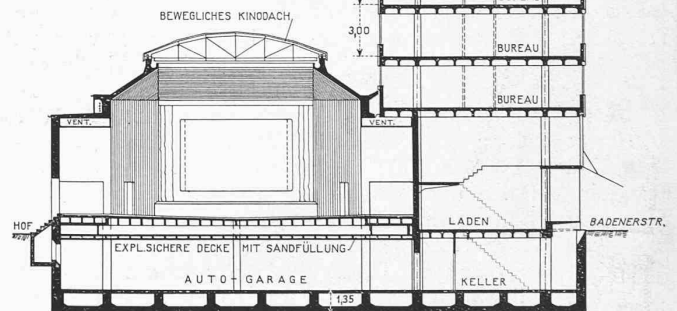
u. 6. Kellergrundriss und Schnitt durch Kino und Bureauhaus. — 1:400.
